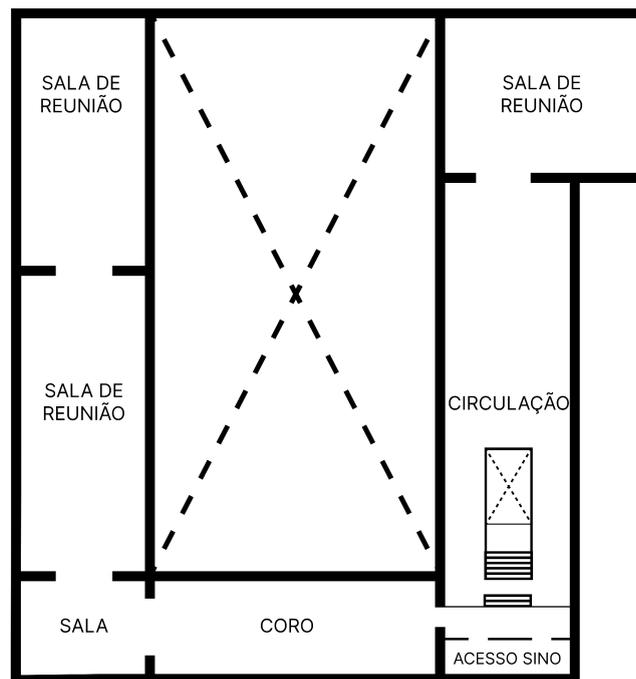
Planta esquemática aproximada do pavimento superior da Igreja paroquial São Lourenço Mártir (sem escala). Fonte: imagem criada pela autora, 2024.
